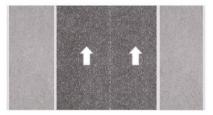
Perfil vial existente -Carrera 36 Fuente: Elaboración propia
